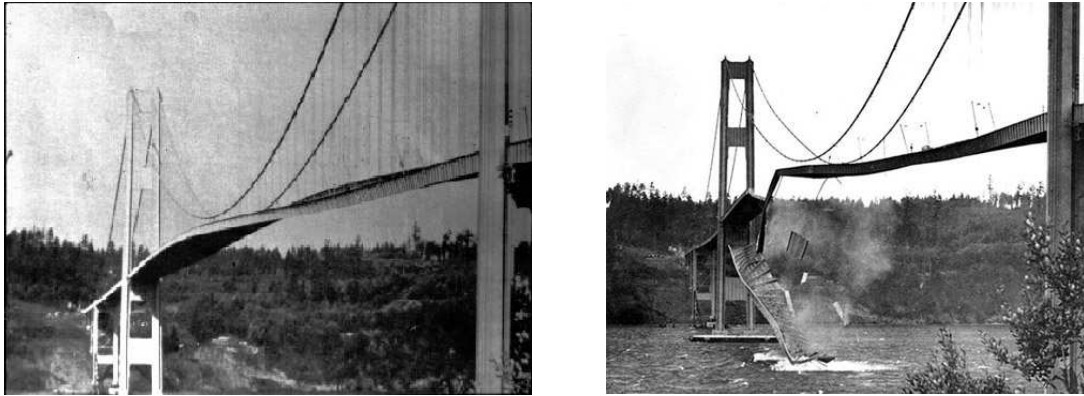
Colapso de Puente Colgante Tacoma Narrows (USA)
